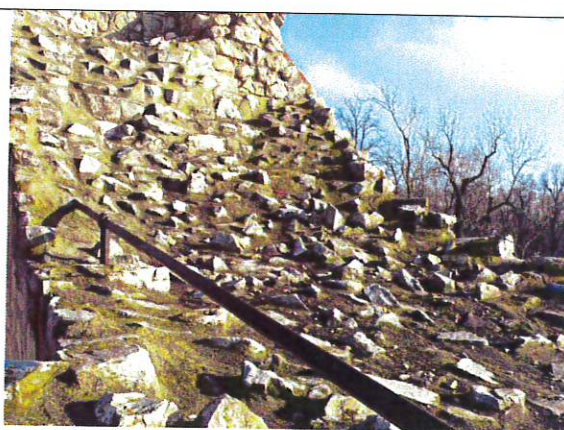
/B Widok muru sekcji od strony wewnętrznej - część od południa
